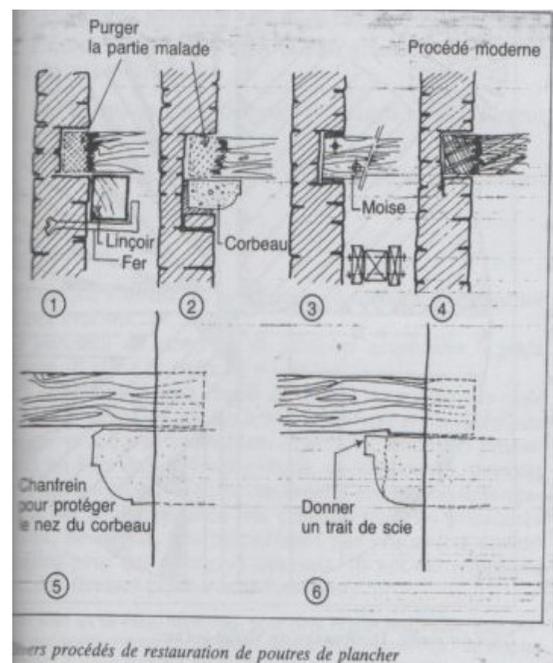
Procédés pour appui des solives et poutres de planchers
